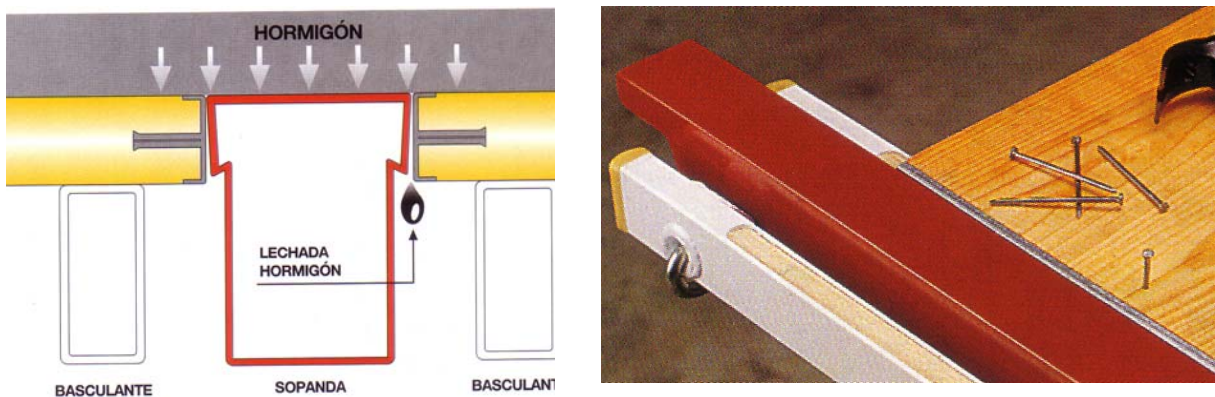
En este sistema se han asegurado los apoyos de los tableros de encofrado en el sistema.
